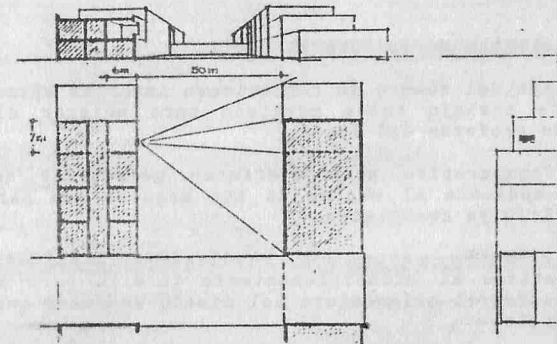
Planta y corte de la ubicación de los obstáculos exteriores.
